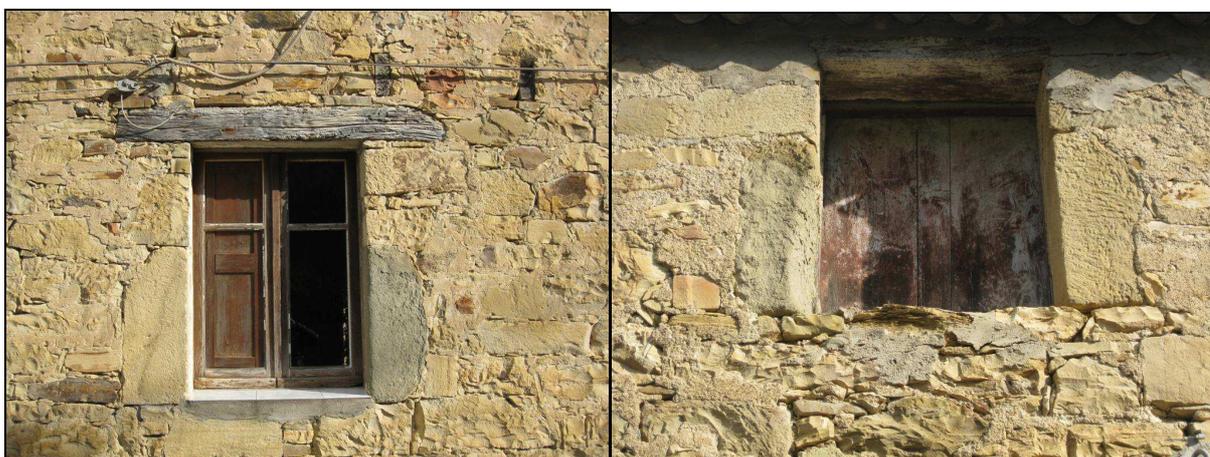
Finestre con architrave ligneo e stipiti in conci lapidei, sbozzati o squadrati, ammorsati alla muratura.
